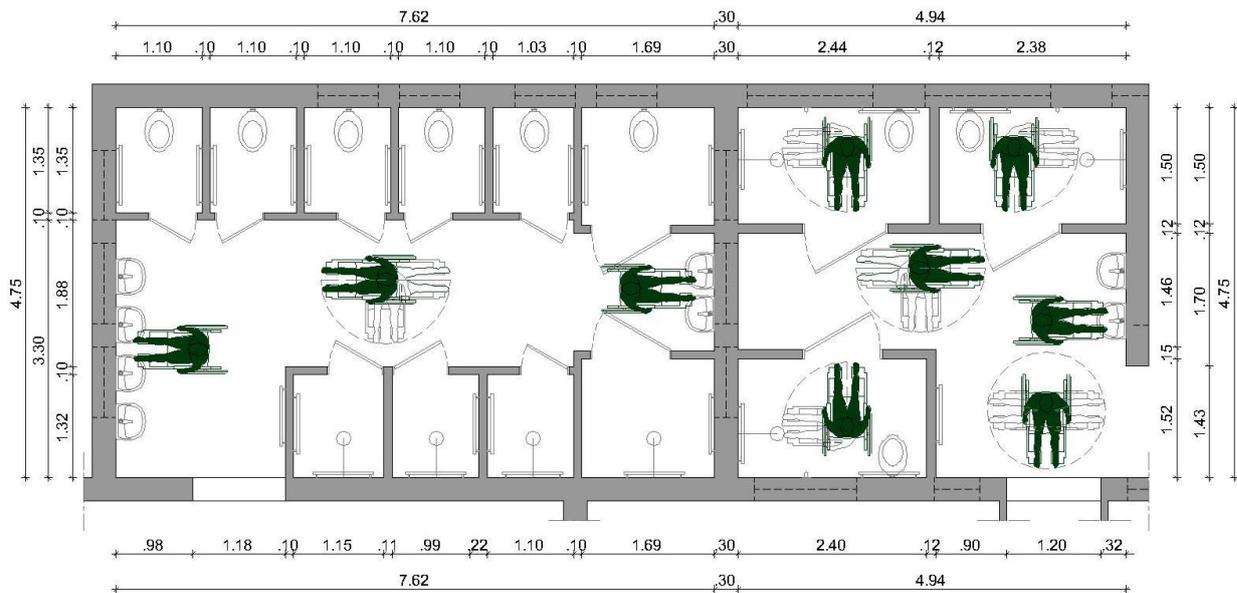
ILPI 2 - Planta baixa banheiro coletivo masculino A.
